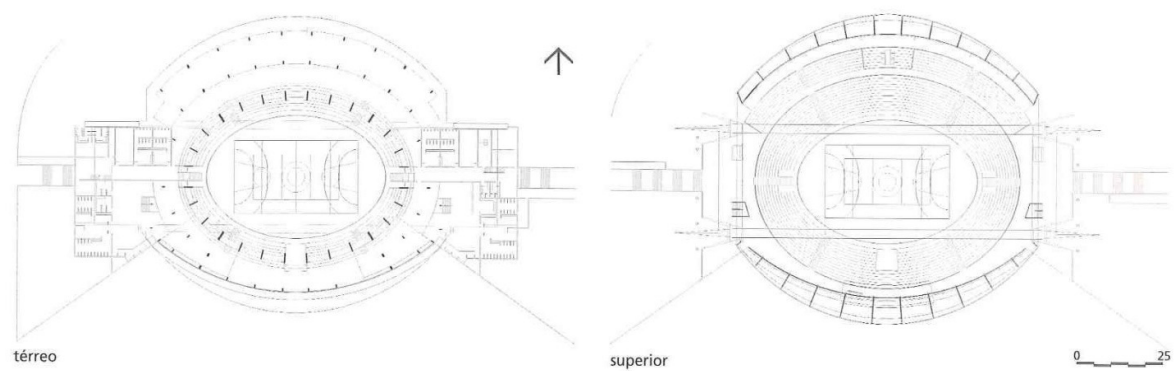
Plantas do projeto do Ginásio de Barueri.
